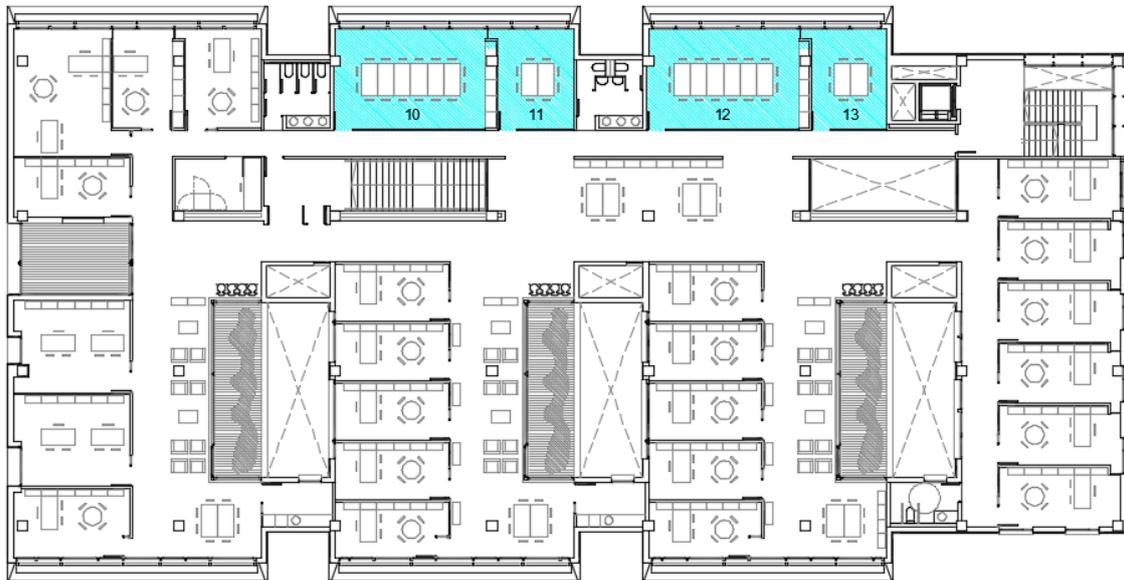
Situación Salas de Reuniones/Tutorías Planta Tercera. Figura extraída del plano 55.
